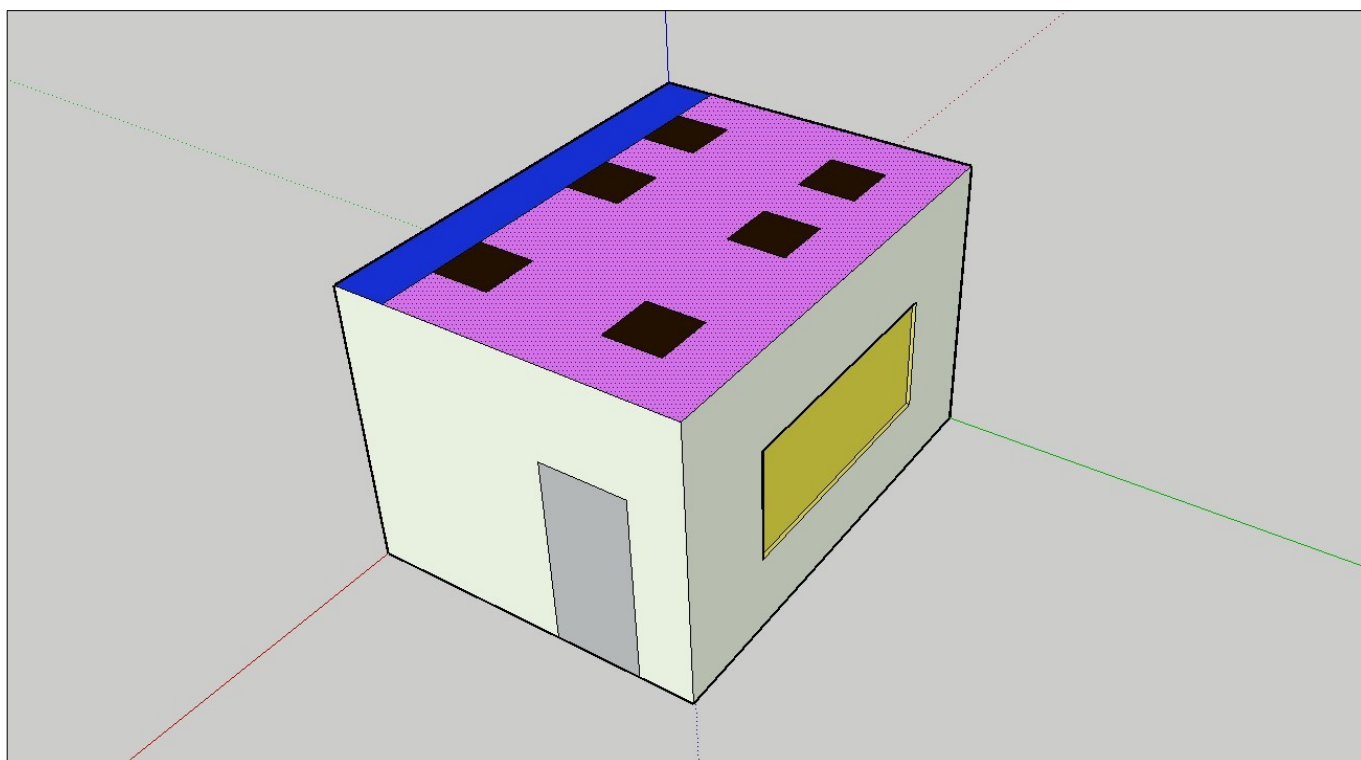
/ Umístění pohltivých obkladů – 2.12 dětská skupina
